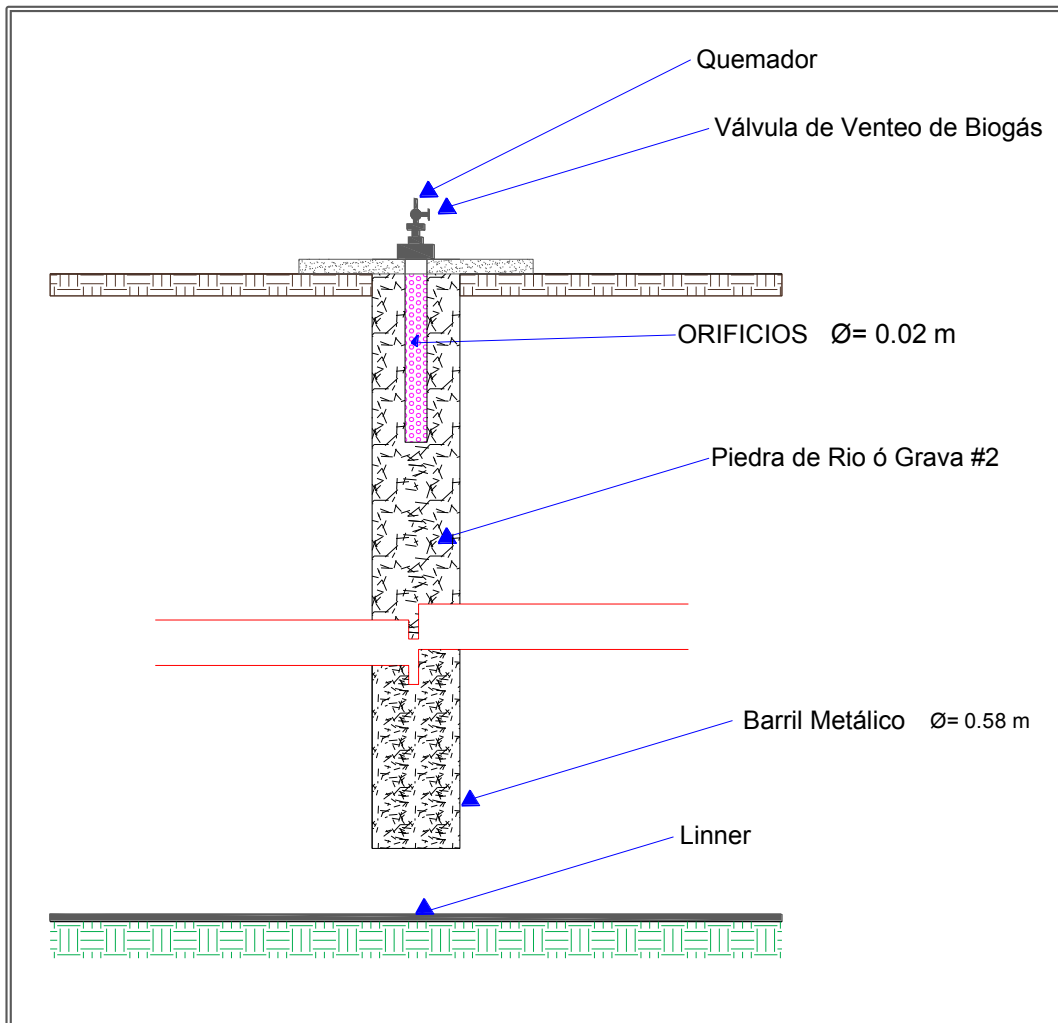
“Detalle de Chimenea para Drenaje de Gases”.
